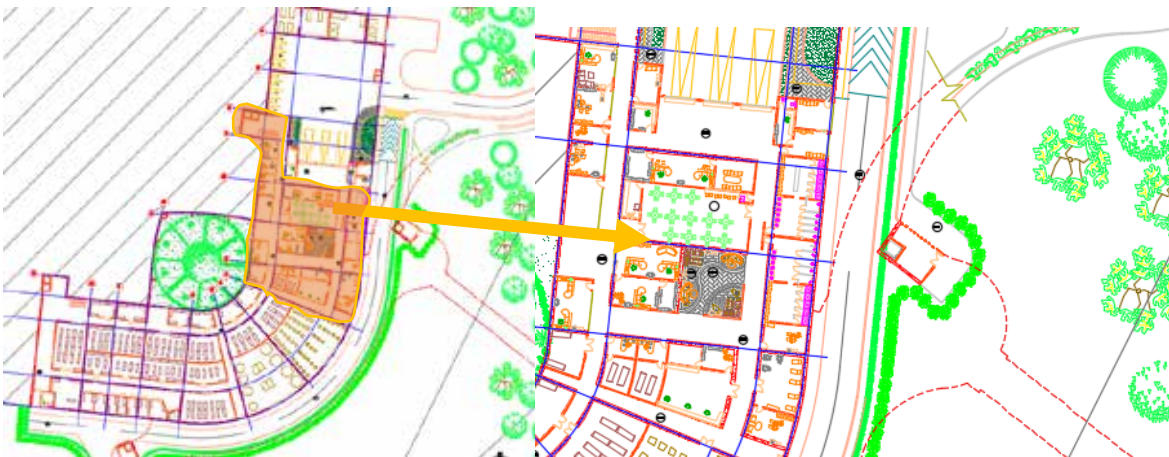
Plano Planta Semi-Sótano con zoom en área de oficinas. (2017).
